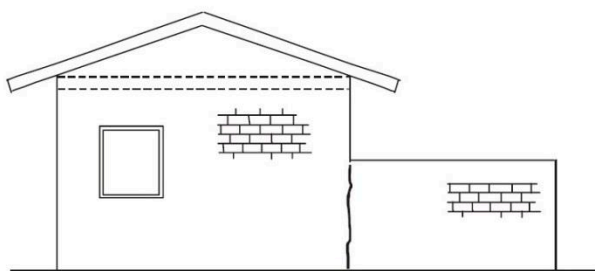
Fissuras verticais por deficiência de amarração entre o prédio e o muro (MAGALHÃES, 2004).
